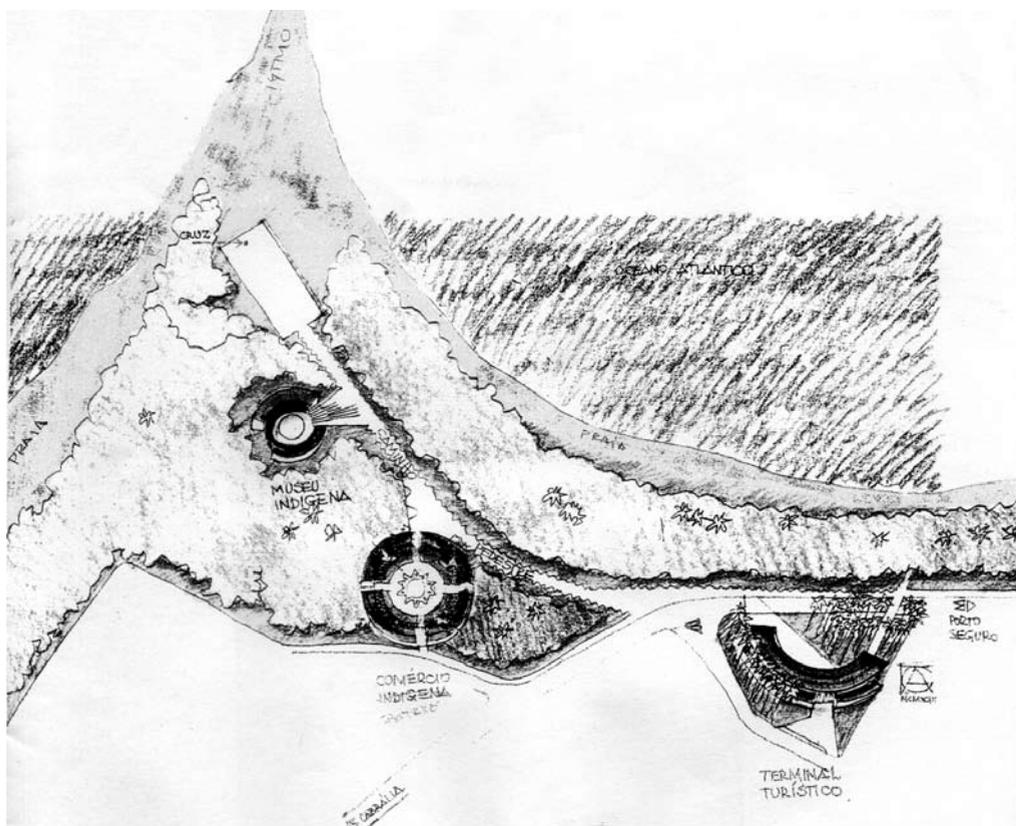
Planta baixa / Coroa Vermelha / Projeto Made
